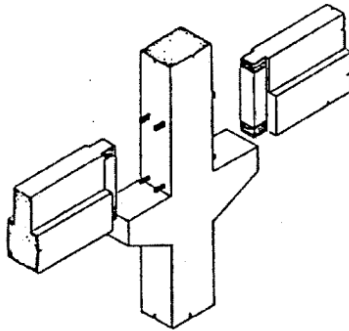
13 Sambungan Basah (In-Situ Concrete Joint)
